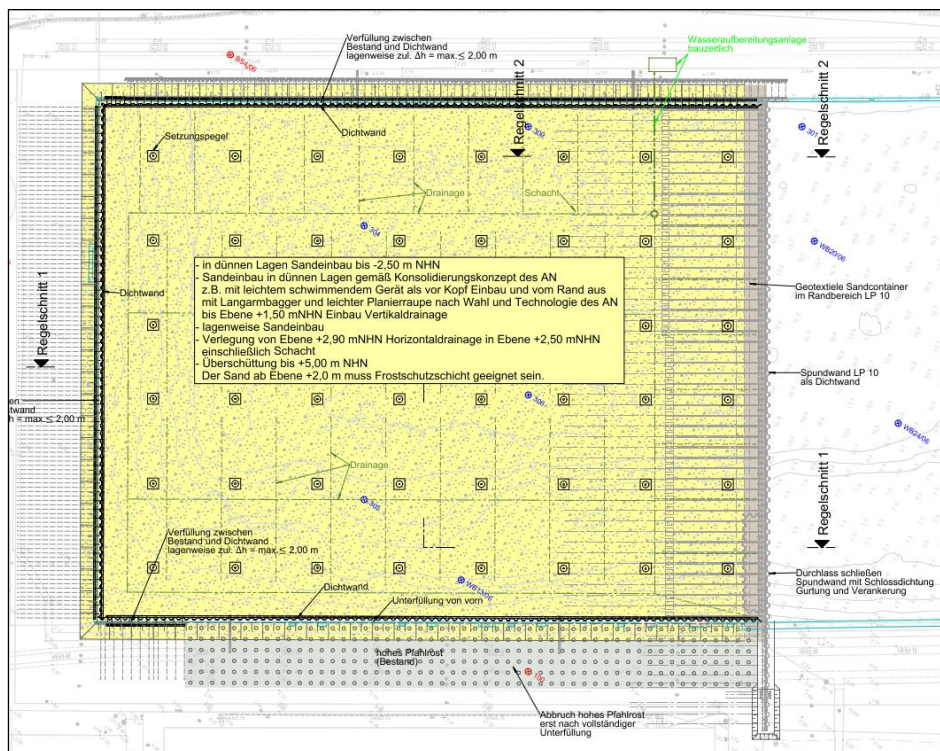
Lageplan Konsolidierung - Auffüllung und Drainage
